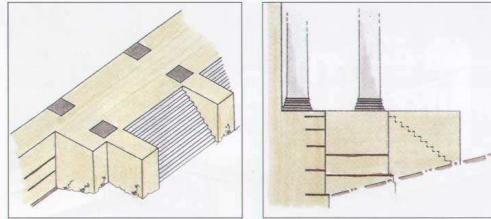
Pronao d'ingresso, lato Sud-Est. La costruzione dell'avancorpo, vincolata dalla pendenza della via Sacra neroniana, ha previsto nel lato Sud una fondazione in parte contro terra ed in parte contro blocchi, ed un elevato, chiaramente collegato con il muro perimetrale della Basilica, con testata in blocchi, contro cui sono state addossate le scale, scandite da setti ortogonali di contenimento. L'iter costruttivo ha previsto la costruzione di A fino alle ammassature; gettata di B contro blocchi, seguendo l'inclinazione della via, con marcapiano di raccordo rispetto al piano di spiccato di A; elevazione di C con testata in blocchi e paramento in laterizio dal marcapiano calibrato sulla massima elevazione della strada all'estremità Est dell'avancorpo, fino al piano di spiccato dei blocchi di fondazione delle colonne.
